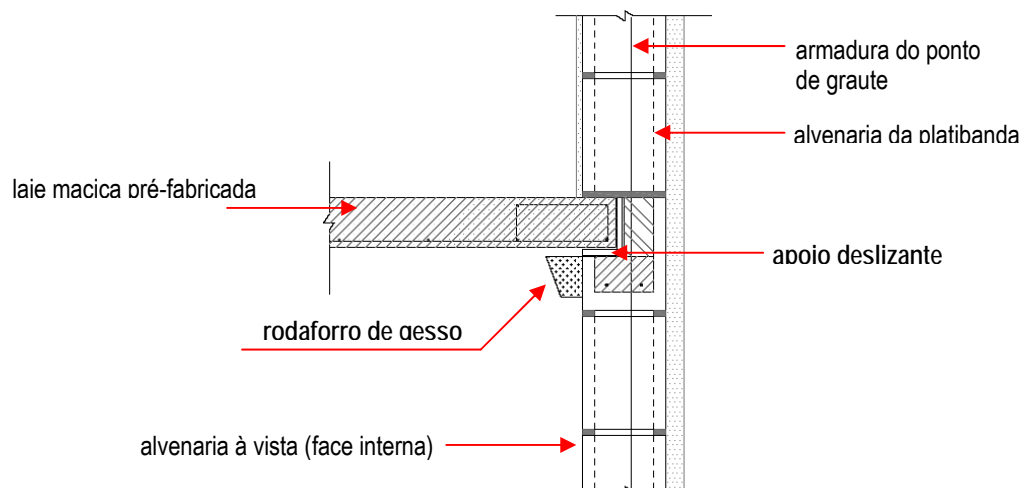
detalhe esquemático do apoio do painel de laje sobre a parede adotado pela empresa E4
